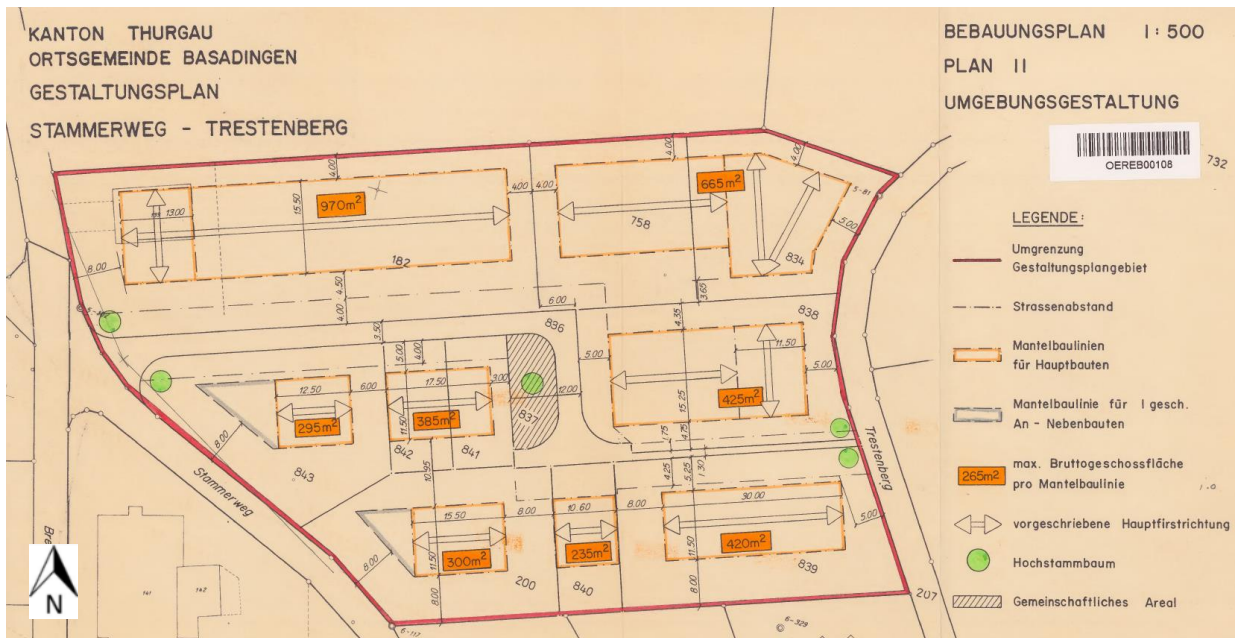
Planausschnitt Gestaltungsplan Stammerweg-Trestenberg
